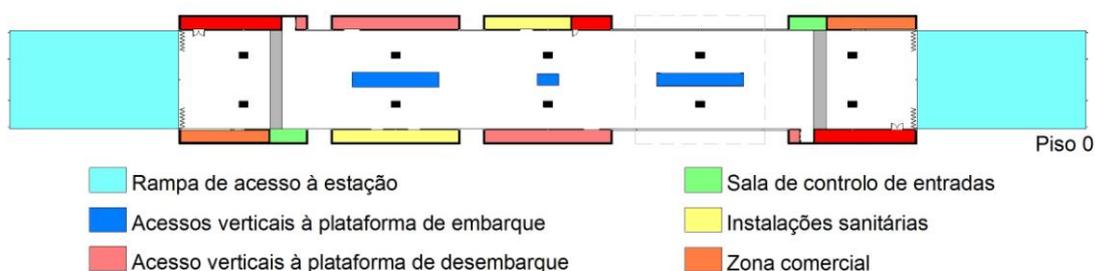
Estação proposta da Zona Franca Litoral- planta geral do Piso 0
